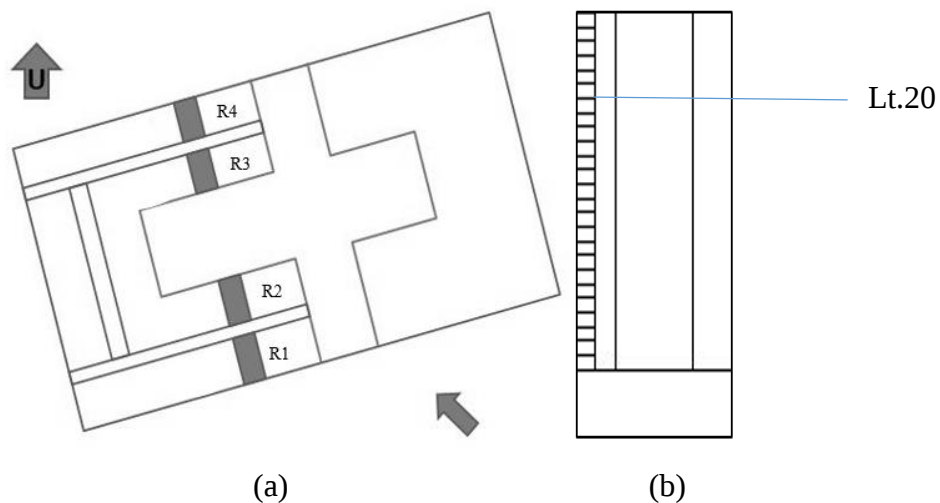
Eksisting Bangunan; (a) Tampak Depan, (b) Balkon
